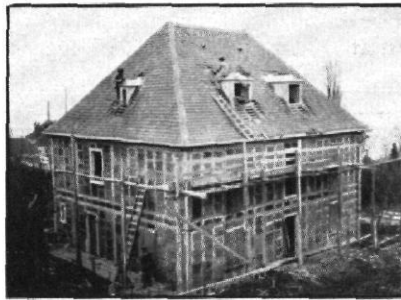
| Das Dach ist eingedeckt, die in der Werkstatt gefertigten Dachgauben sind aufgesetzt
